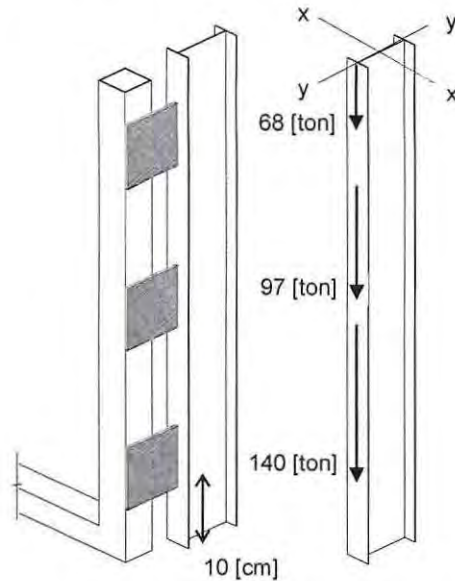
Esquema carga de compresión puntos de conexión con refuerzo estructural.
